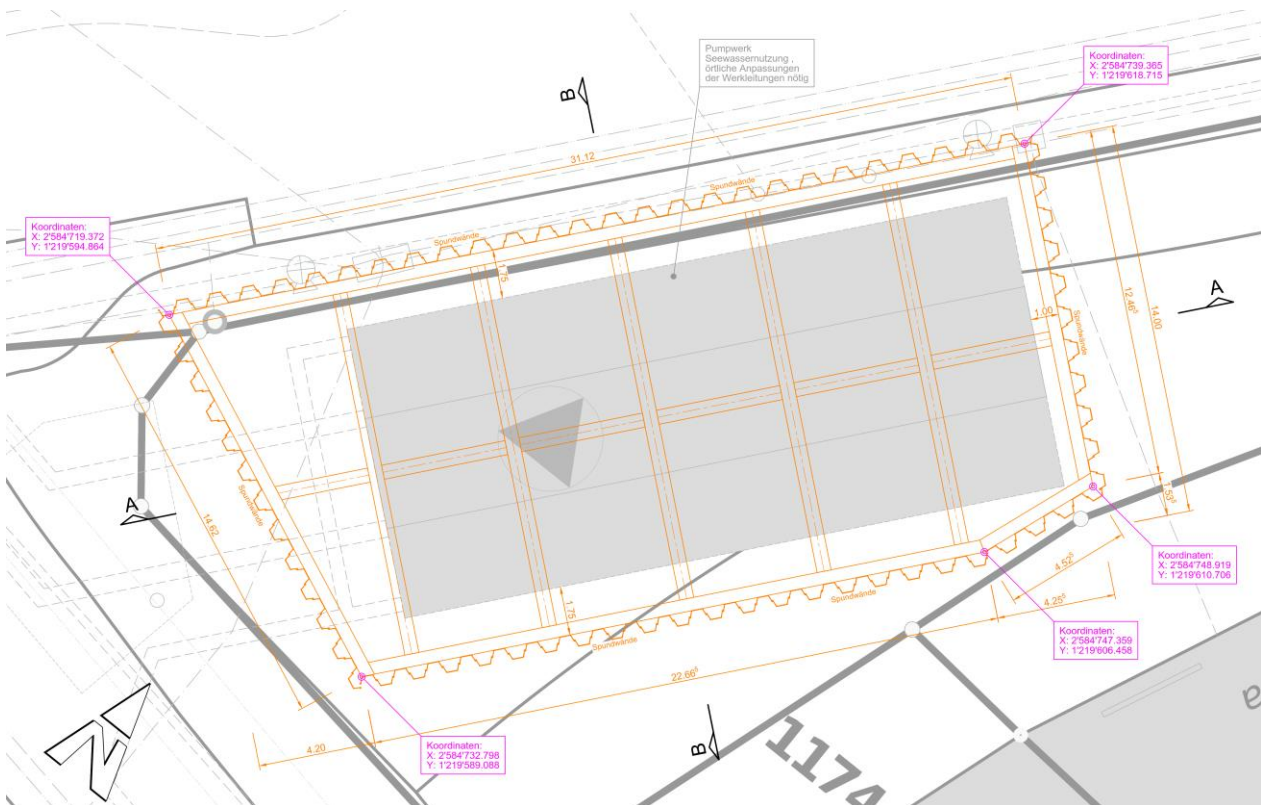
Grundriss Baugrubenabschluss
